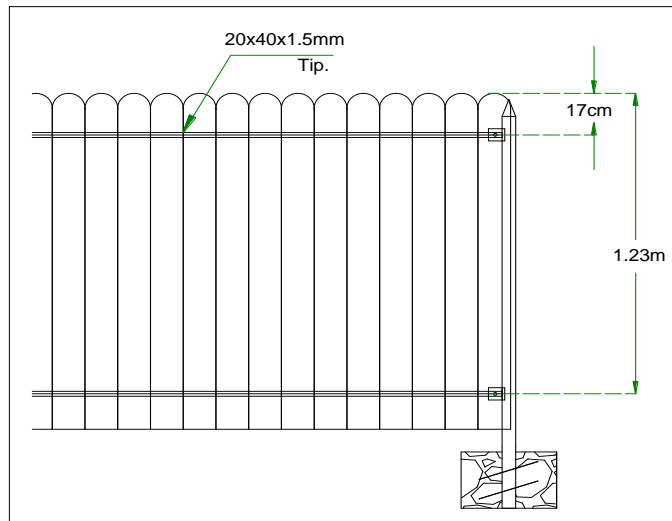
Distancia Perfiles Horizontales 20x40x1.5 mm .b)Fuente: Propia
